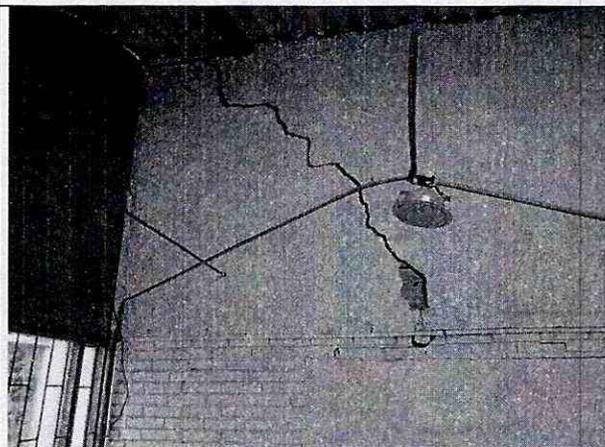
Agrietamiento en muro del segundo piso occidental.
